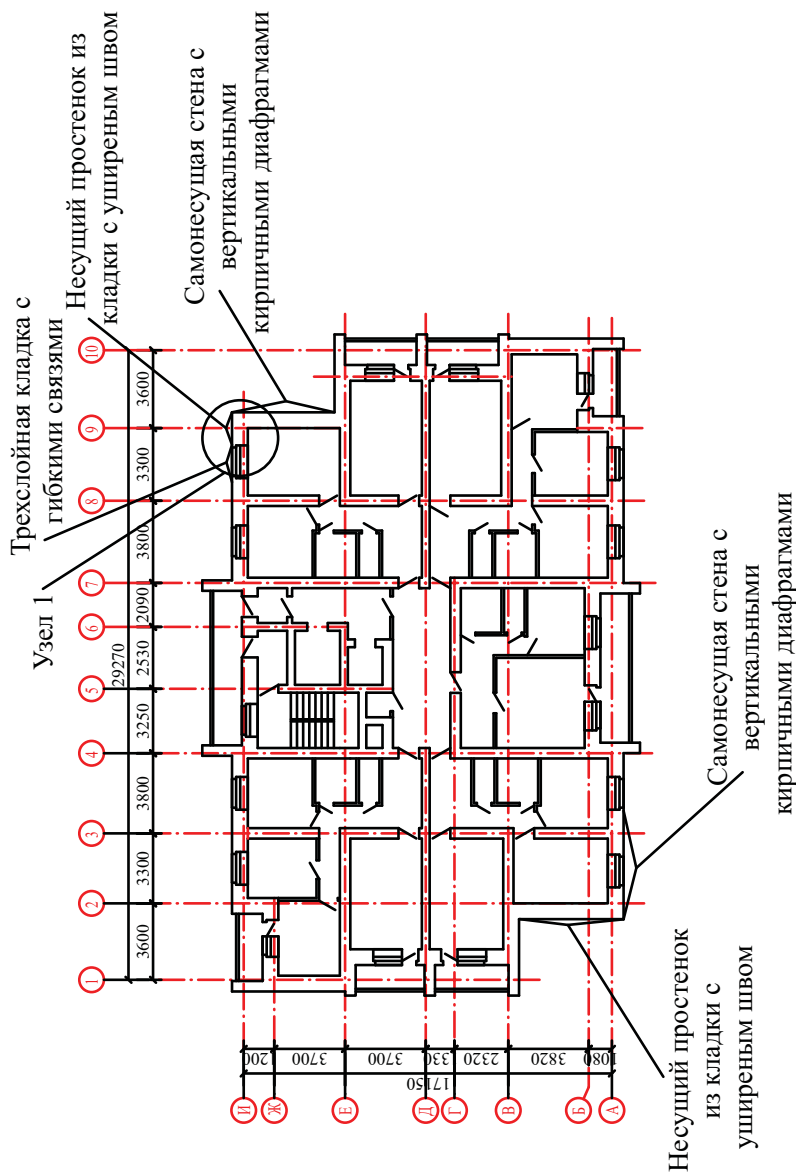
а План типового этажа 10-этажного жилого дома, Кашира, 1997 г.
